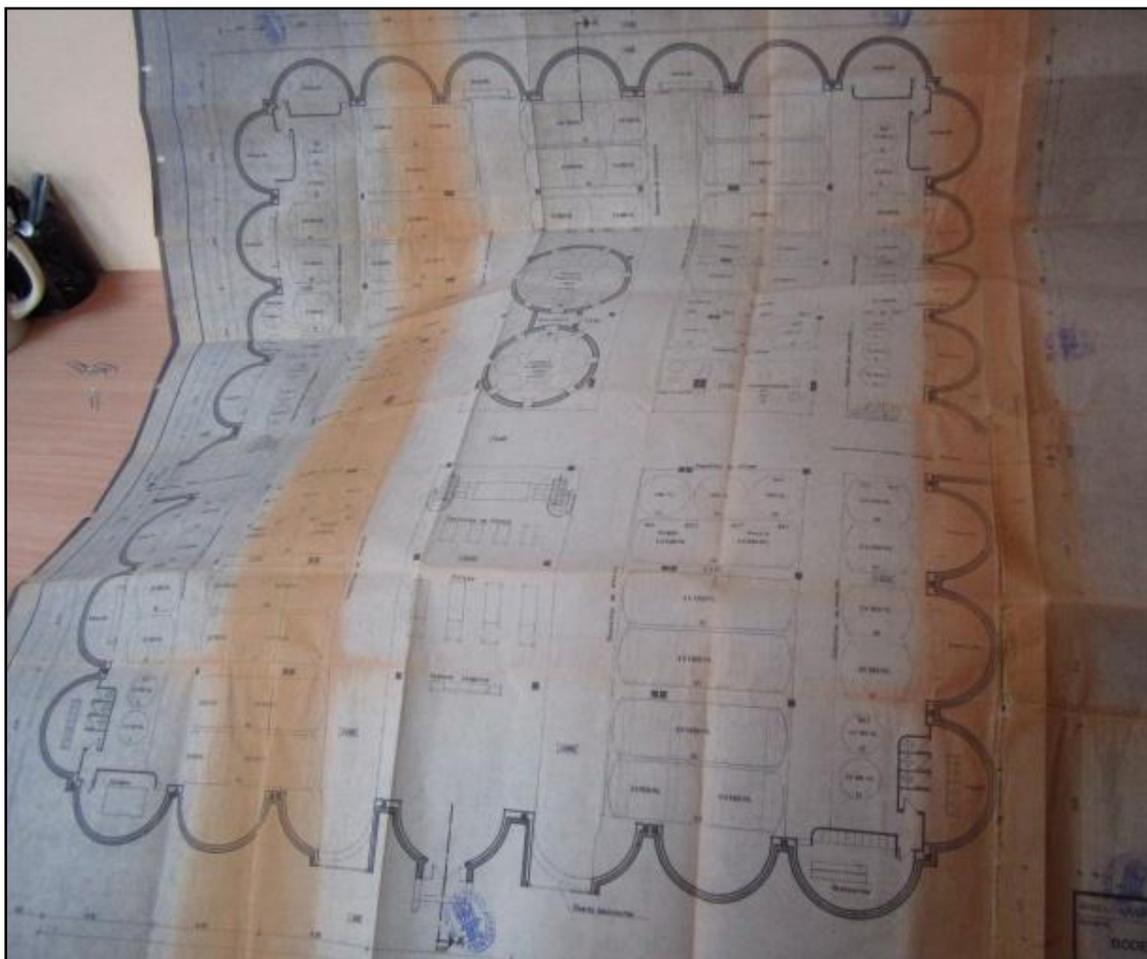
Plano nº 14 de planta baja acotada de la bodega. (Fuente: AMA)
